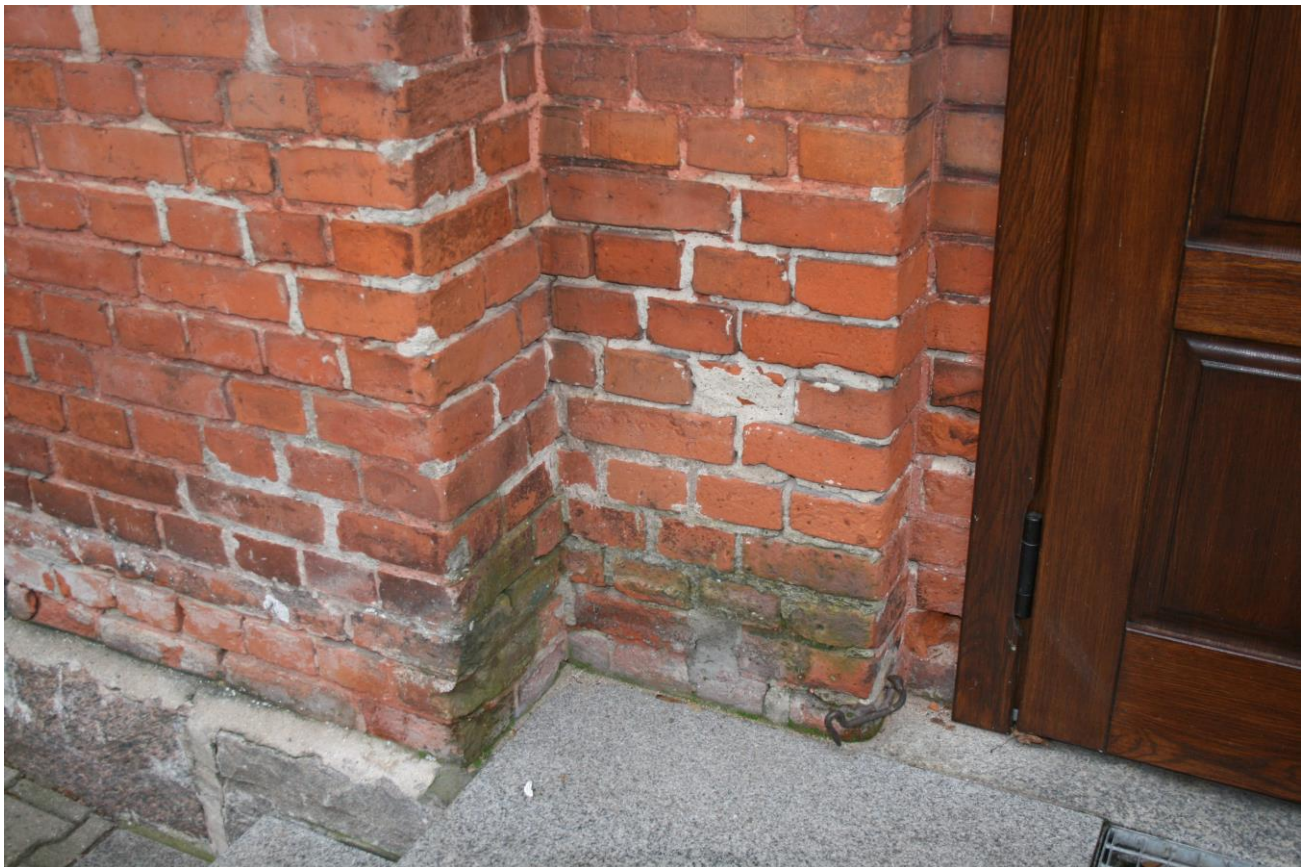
Ściana cokołu – widoczna degradacji spoin. Widoczne zabrudzenia elewacji.
